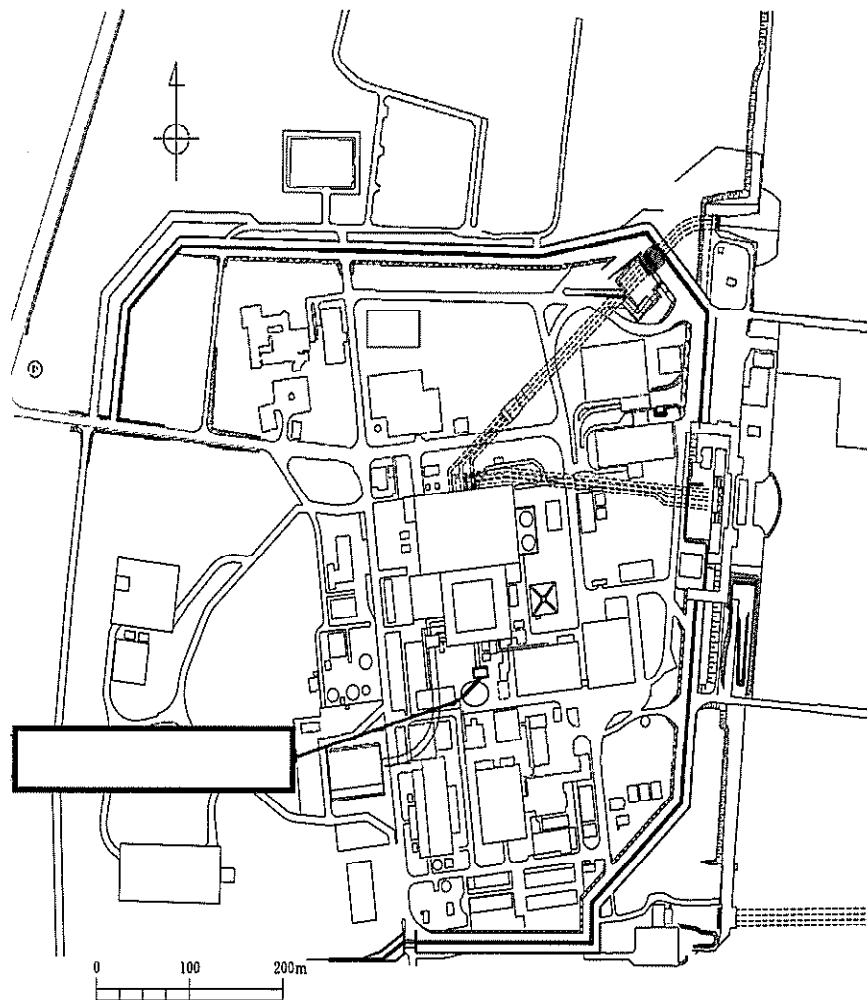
(1) 常設低圧代替注水系ポンプ室 平面配置図 (全体平面図)
